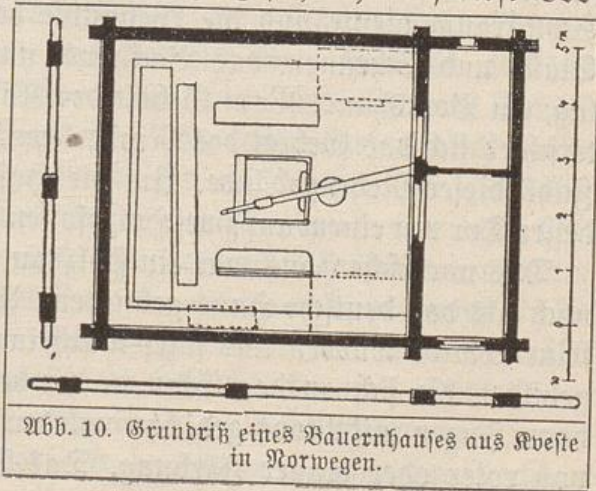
Grundriß eines Bauernhauses aus Kveste in Norwegen.
